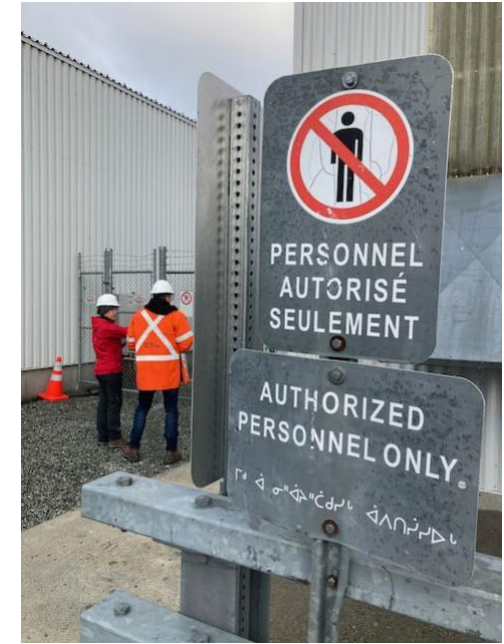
Panneaux d'avertissement au barrage Bernard-Landry en trois langues
